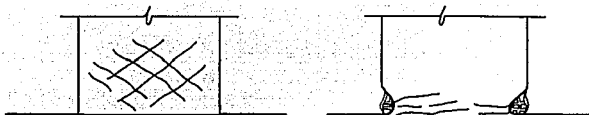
DAÑOS EN VIGAS Y UNIONES
